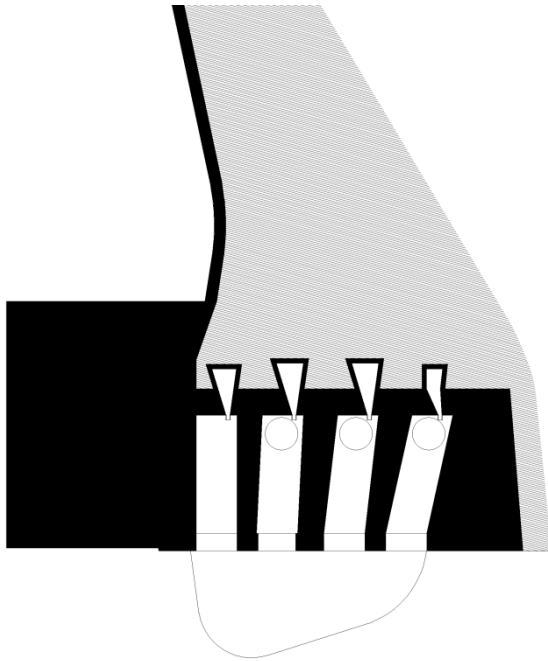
Planta do Meio Piso (Fonte: do autor)
